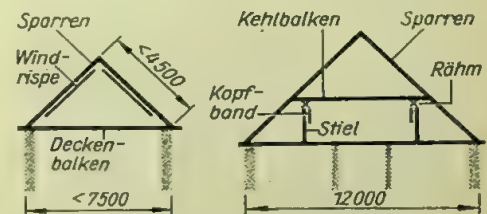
Sparrendach (links) und Kehlbalkendach mit doppelt stehendem Stuhl (rechts)
